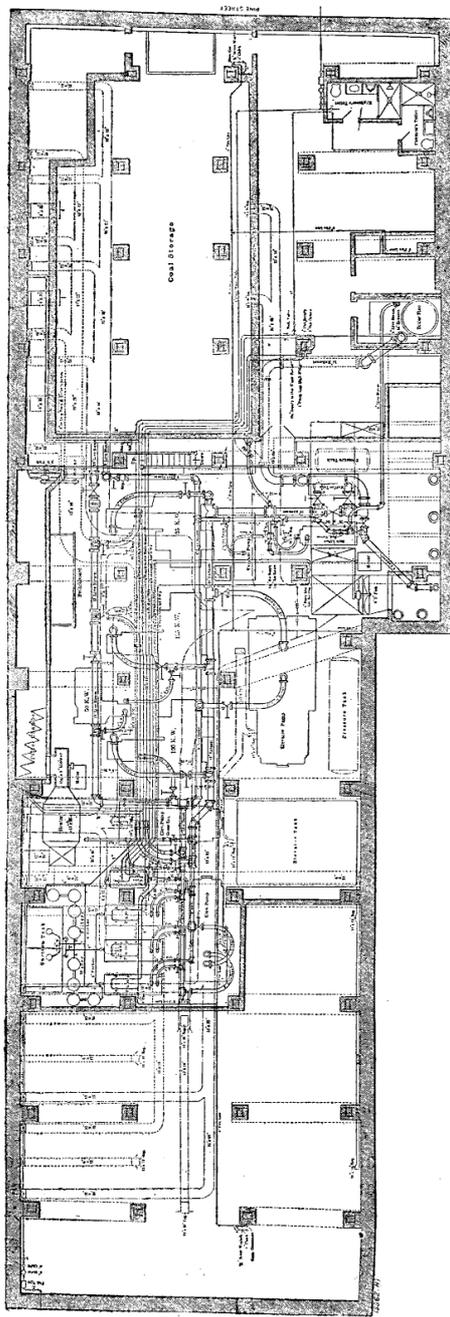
Machinerie-du N° 60 Wall St, New-York.
